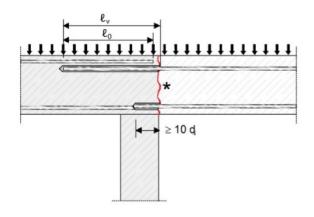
Нахлесточное соединение в фундаменте колонны или стены, где арматурные стержни находятся под растягивающим напряжением.
